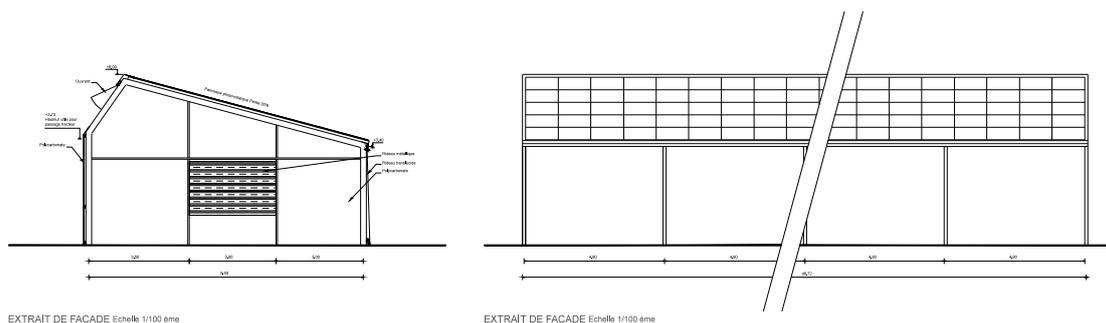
Extrait du PC5 : plan des façades et toiture joint au dossier de demande de permis de construire
